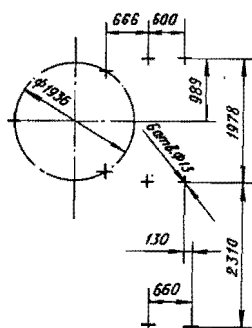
План расположения отверстий под фундаментные болты резервуара сливкосогревательного марки Л5-ОТН-6300
